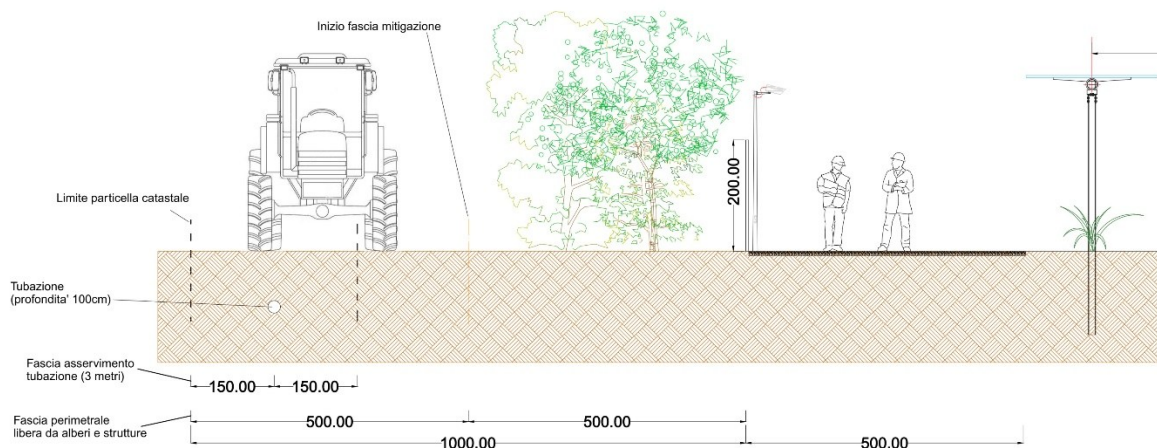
Sezione tipo della fascia perimetrale con tubazione e relativa fascia di asservimento.
